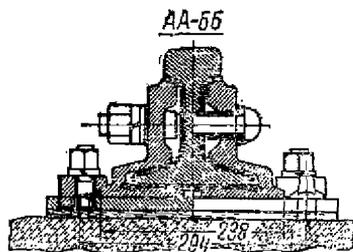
Изолирующий стык рельсов для пути на железобетонных шпалах с шурупным креплением подкладок
